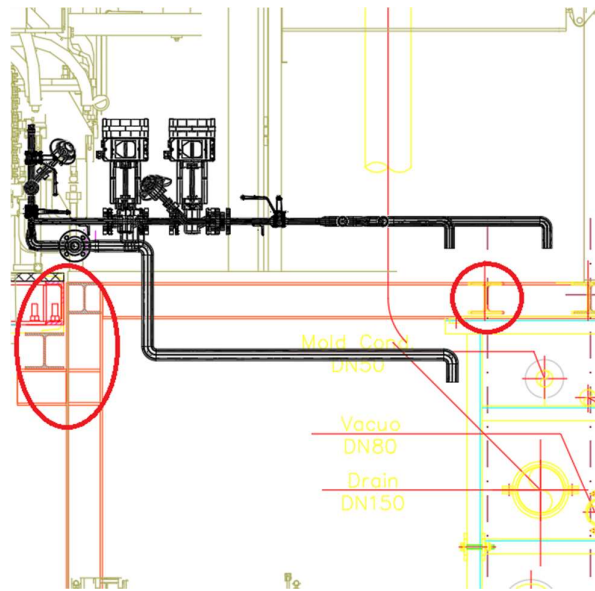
Integração do kit para o aquecimento externo no layout - vista em corte do canal
